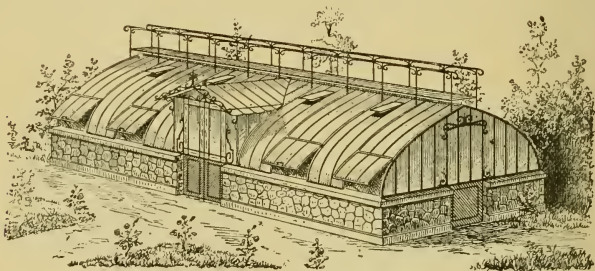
Serre en fer à deux versants; comble et pied convexes; galerie au sommet; porte en lucarne; panneaux d'aérage.
